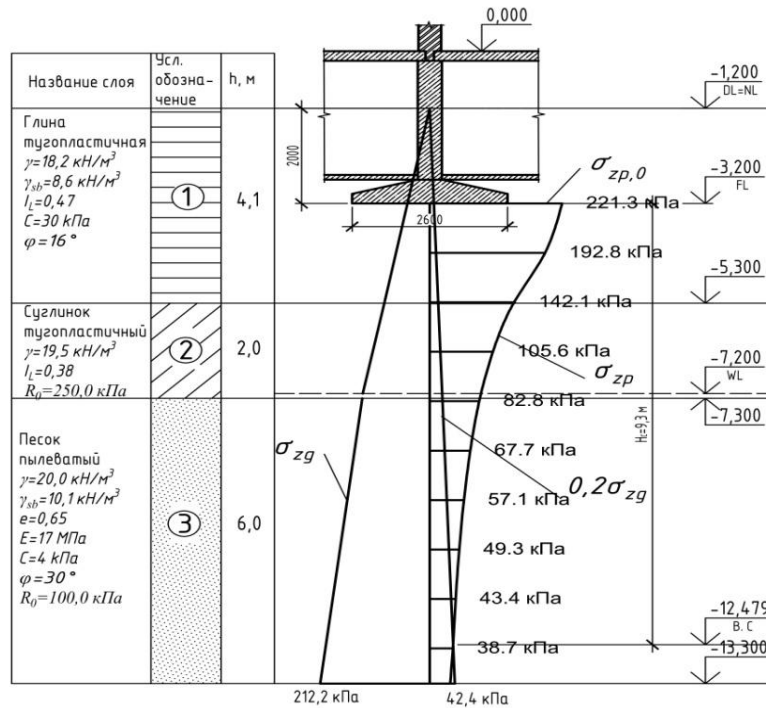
Схема осадки фундамента мелкого заложения
